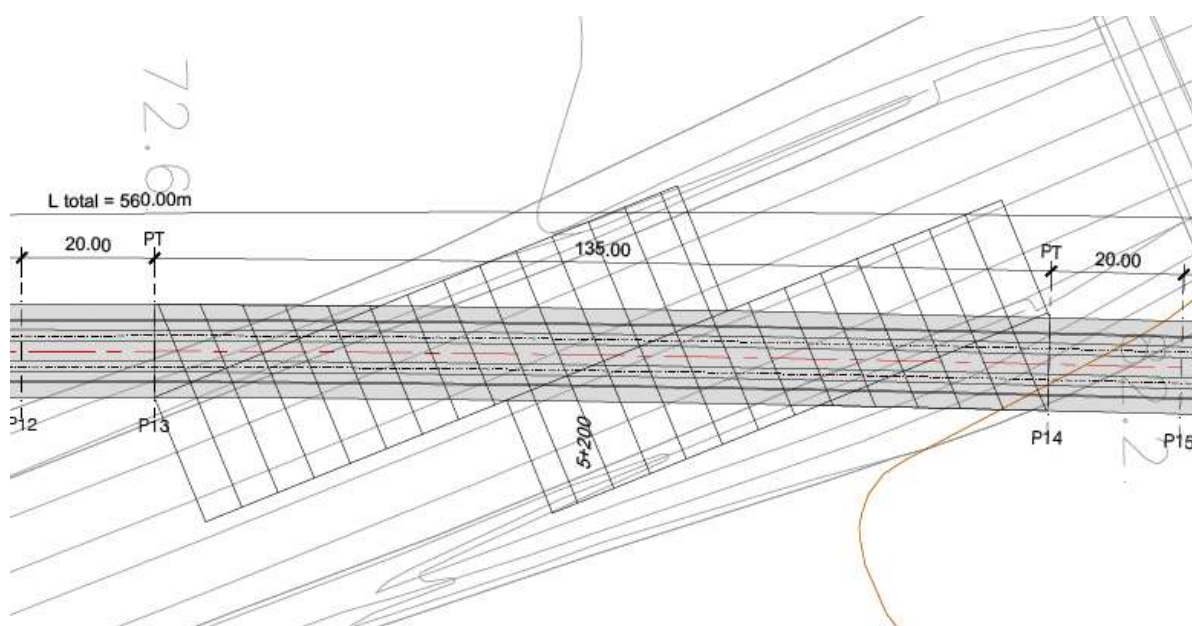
Vista em planta da solução de “fly over” sobre uma auto-estrada.
